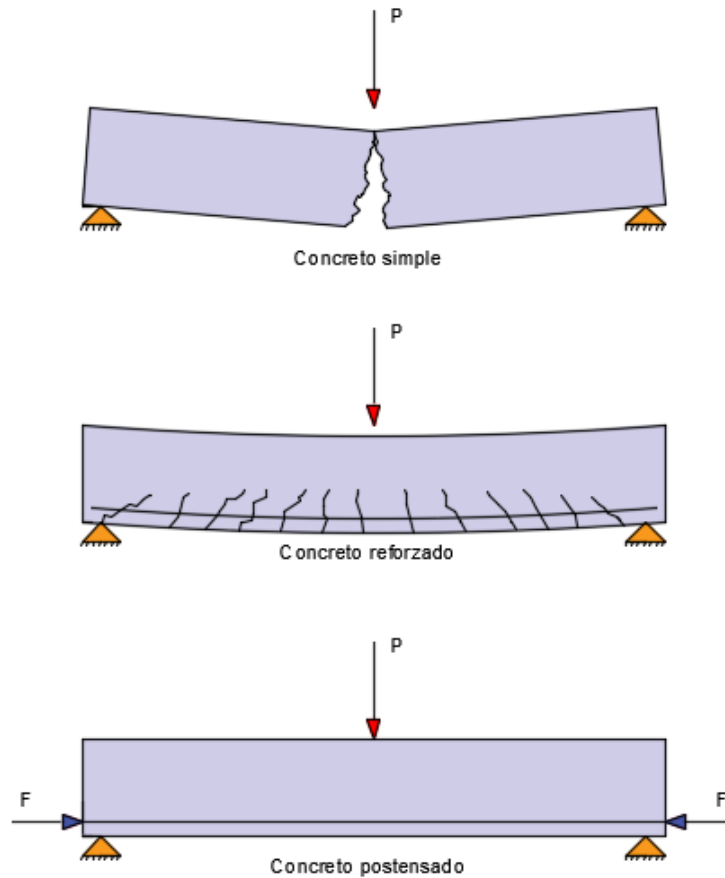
Concreto simple, concreto reforzado y concreto postensado ante cargas de servicio
